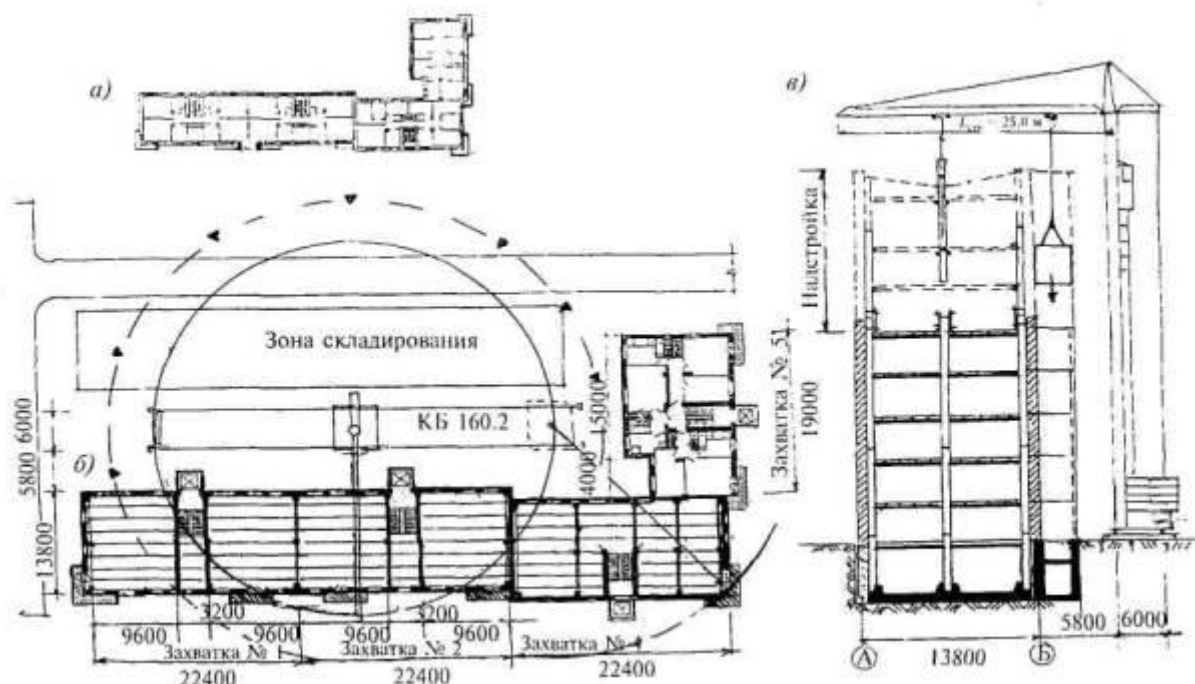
Технологическая схема реконструкции жилого дома с использованием встроенного каркаса с широким шагом колонн
